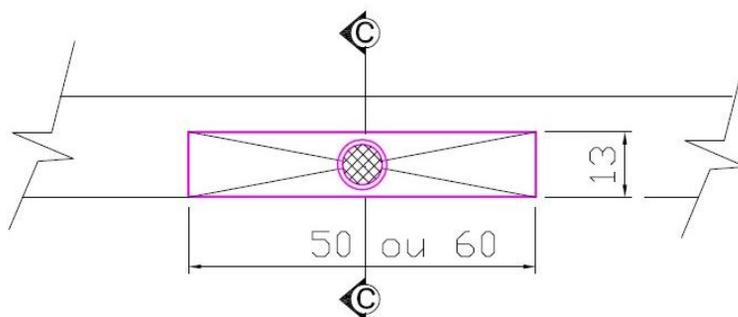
TAMPAS dn 3/4" – PARA ATÉ 04 MÓDULOS.
